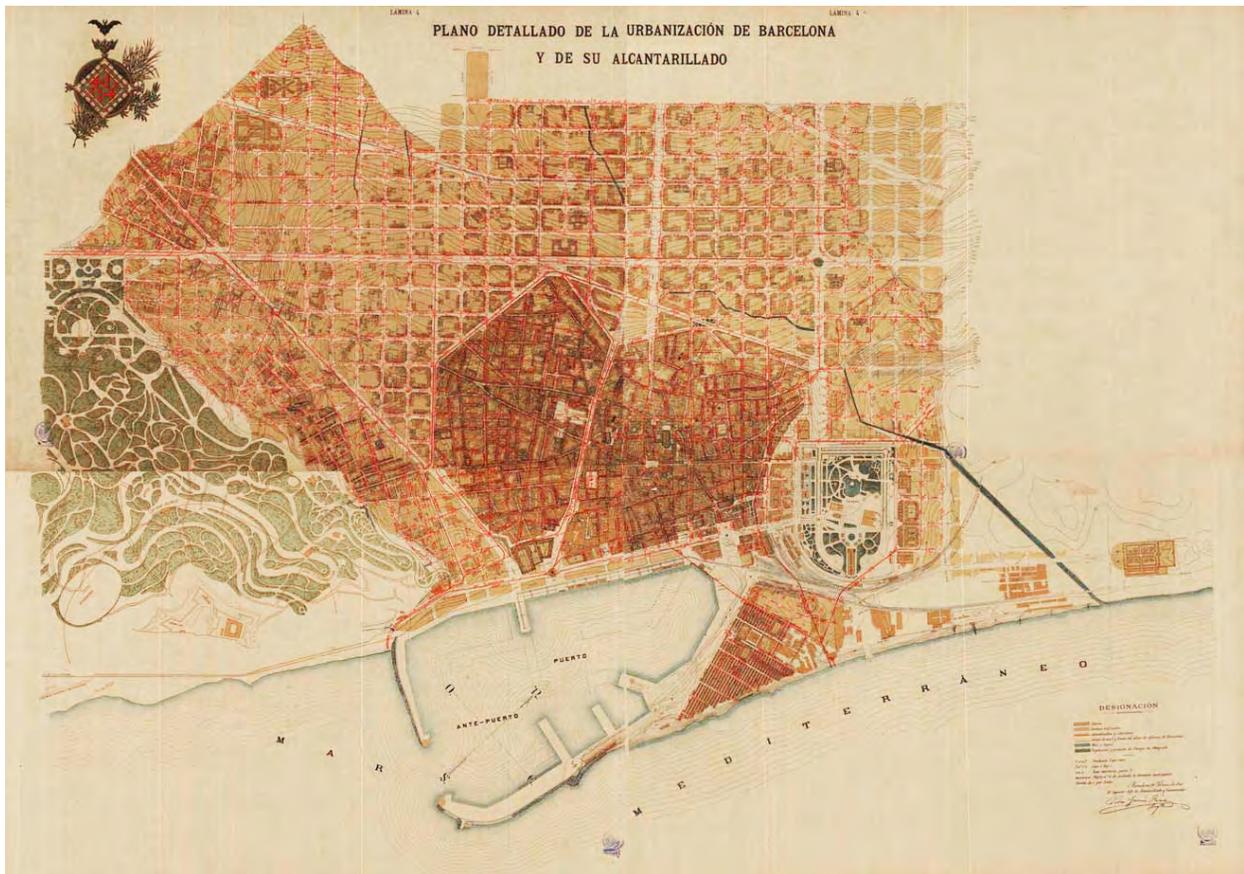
Proyecto de García i Faria para el alcantarillado e infraestructuras de Barcelona
